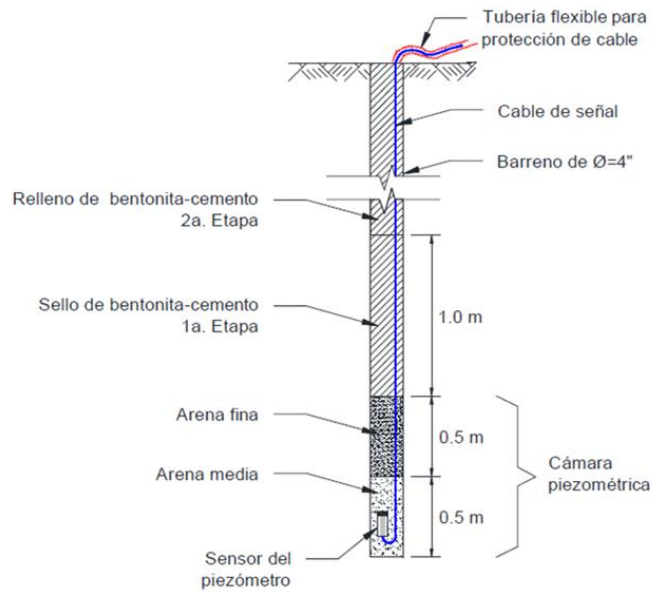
Instalación de piezómetros del tipo eléctricos.
